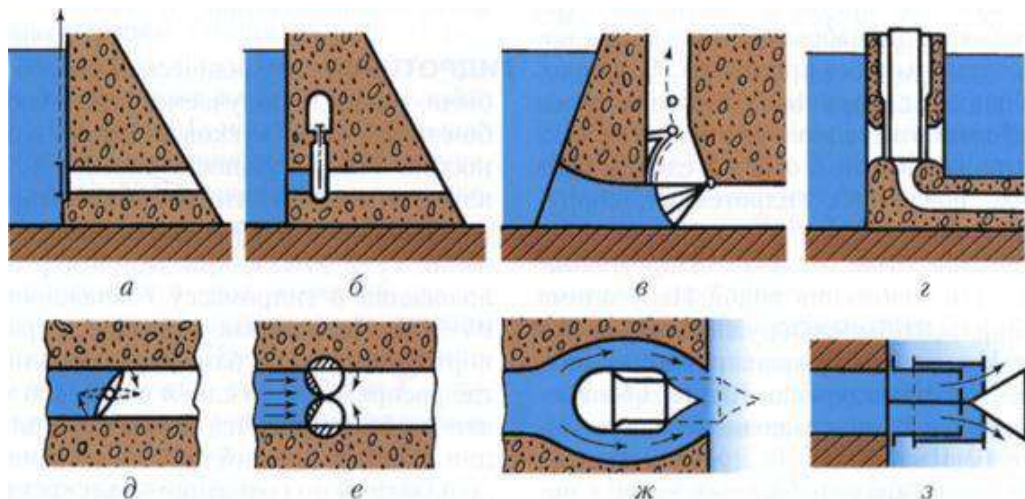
Схемы глубинных затворов: а – плоский; б – задвижка; в – сегментный; г – цилиндрический; д – дроссельный; е – шаровой; ж – игольчатый; з - конусный
